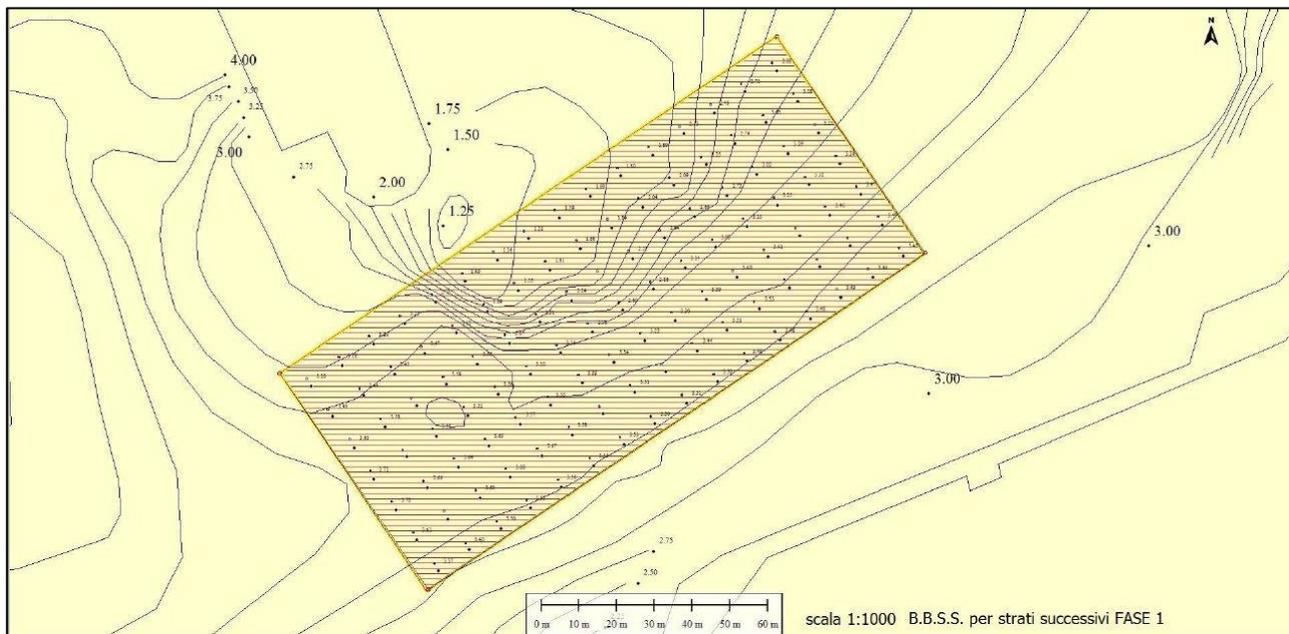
Planimetria area di dragaggio (11.200 mq)
